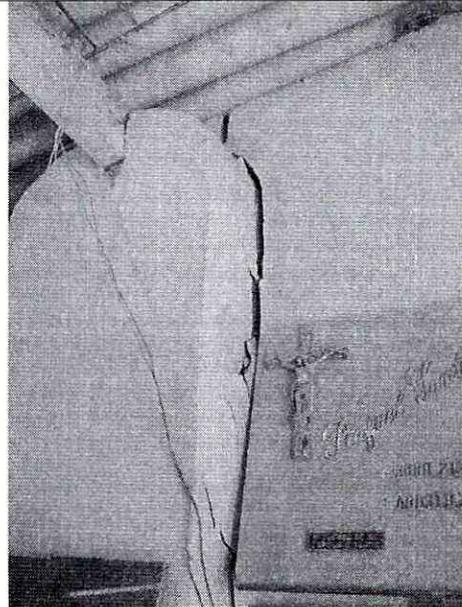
Grietas severas en muro divisorio entre los locales comerciales del costado nororiental del predio.
